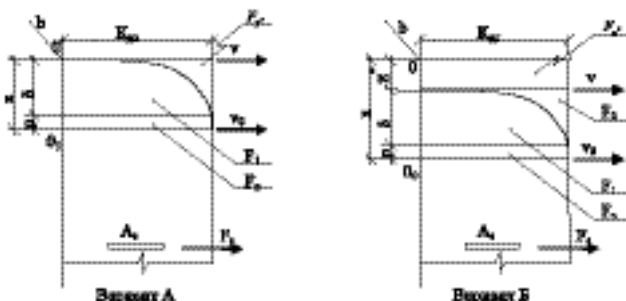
Схема напряженного состояния поперечного сечения продольного изгибаемого железобетонного элемента
